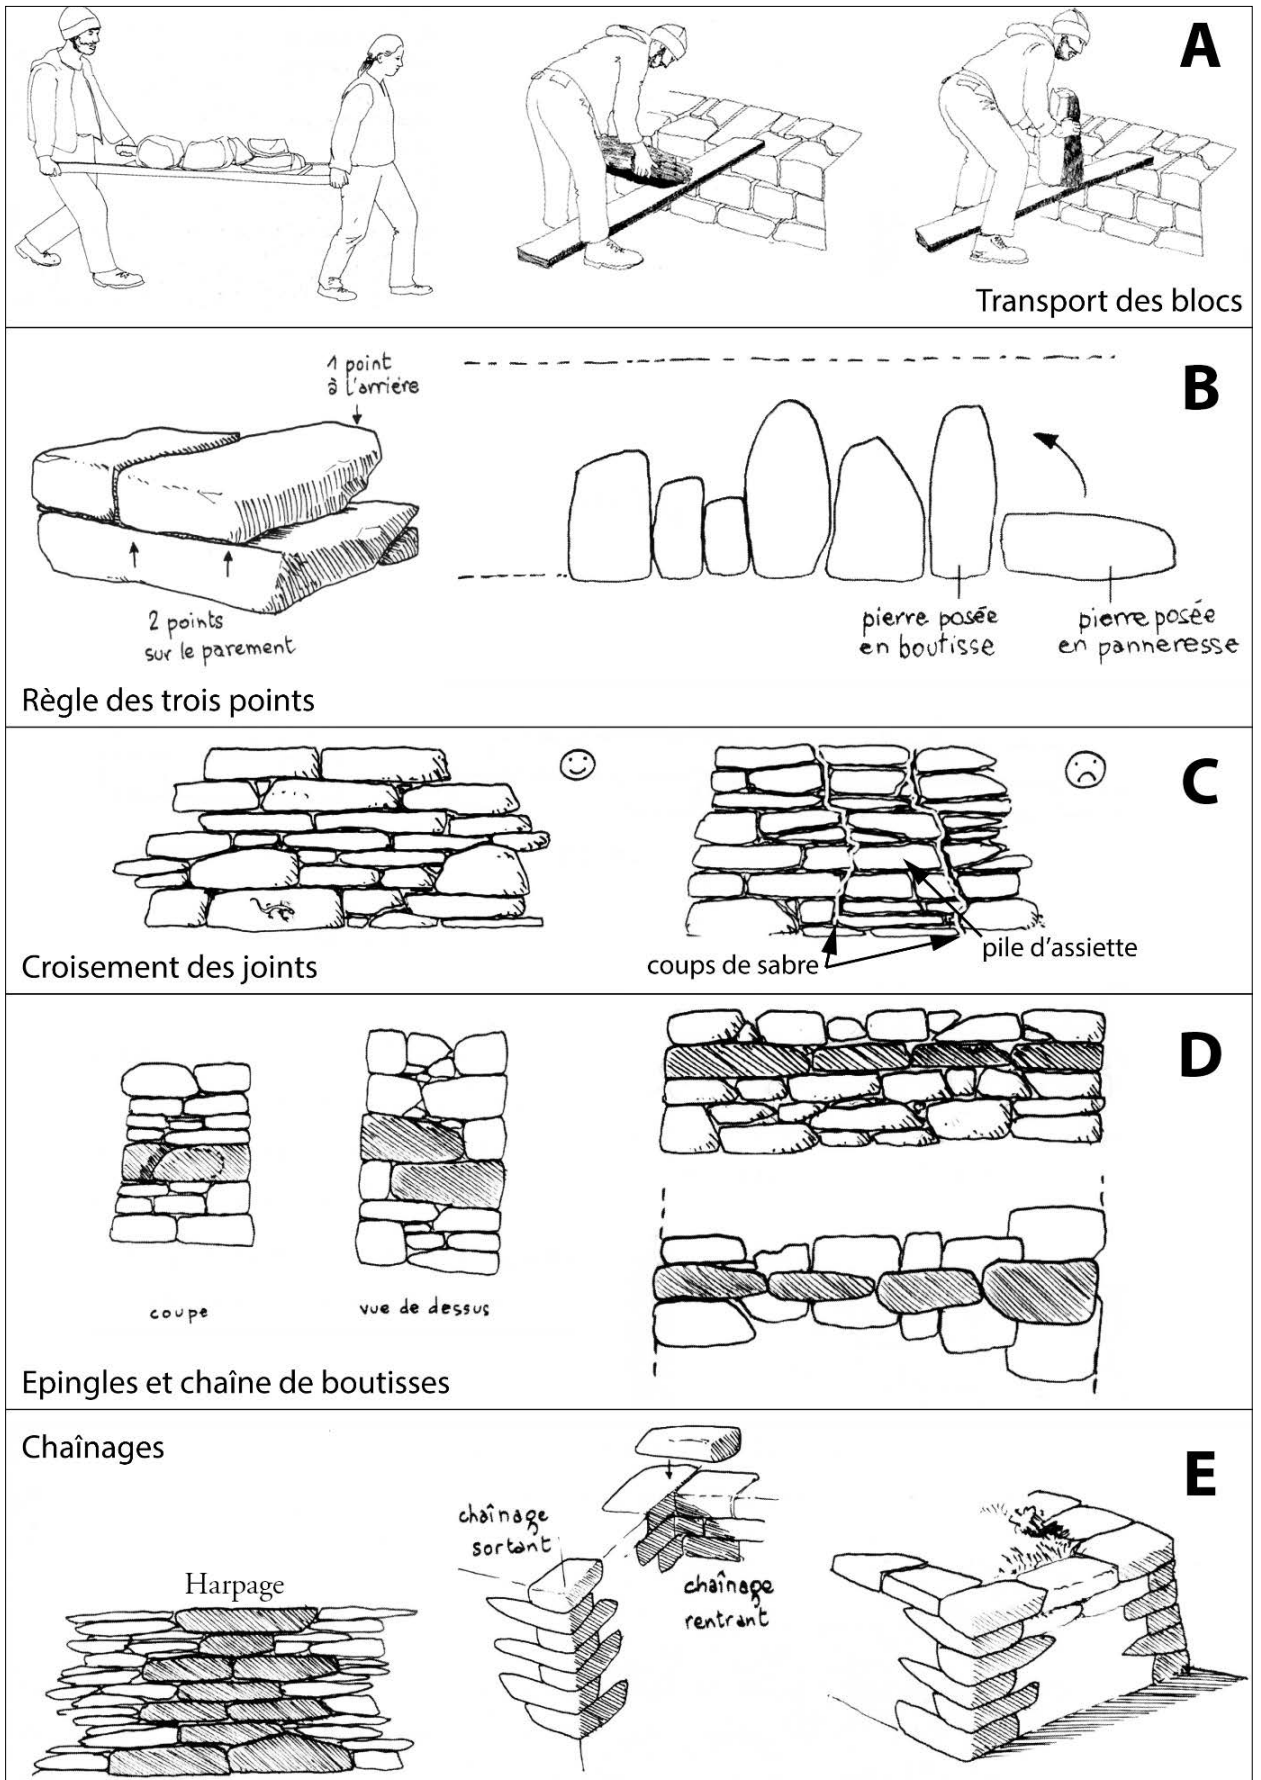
Chantier de construction d'un mur en pierre sèche. A: Transport des blocs (Lassure 2008) ; B, C, D, E: Pose des blocs (CAPEB 2008).
